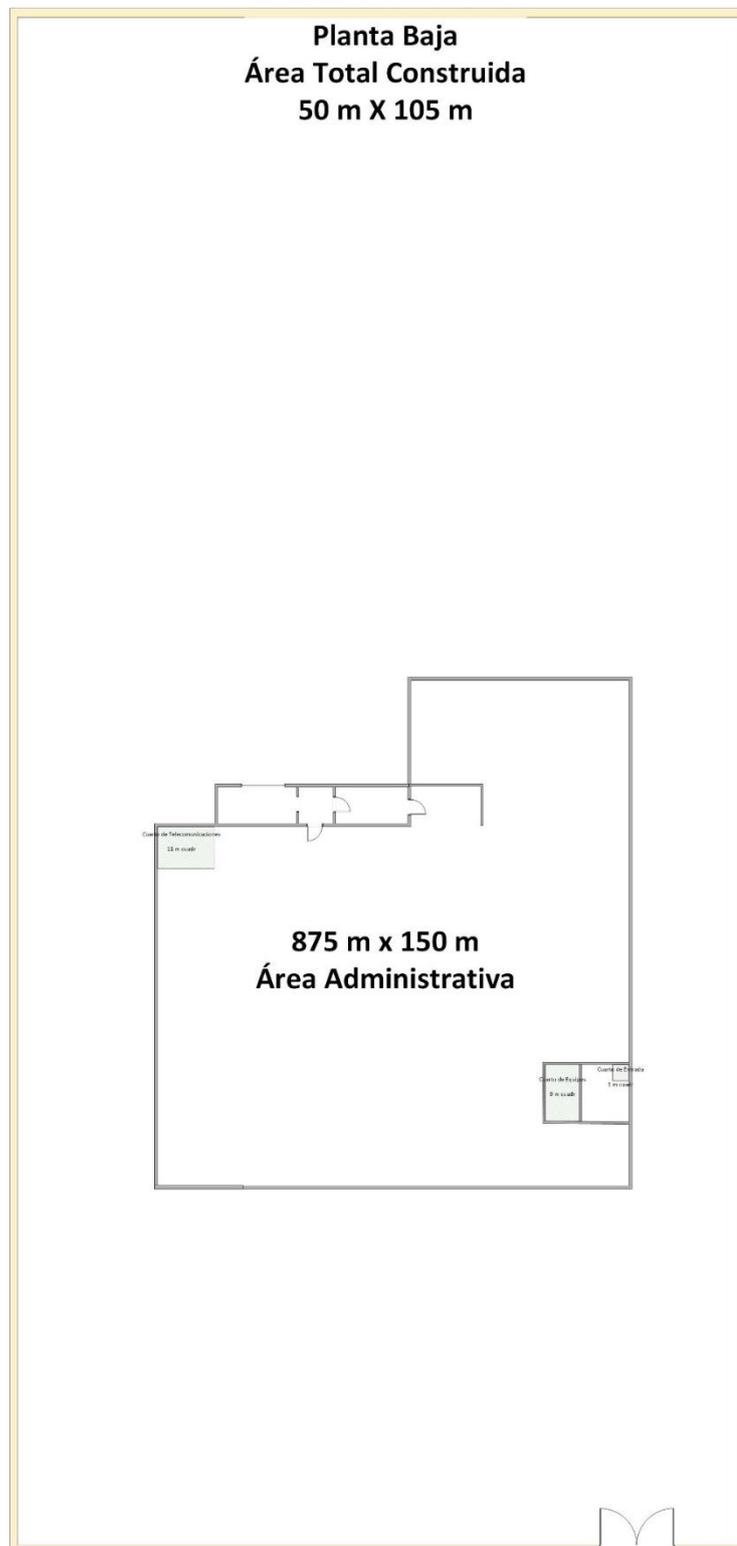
Diseño General de la Estructura de Hotel, Planta Baja.
